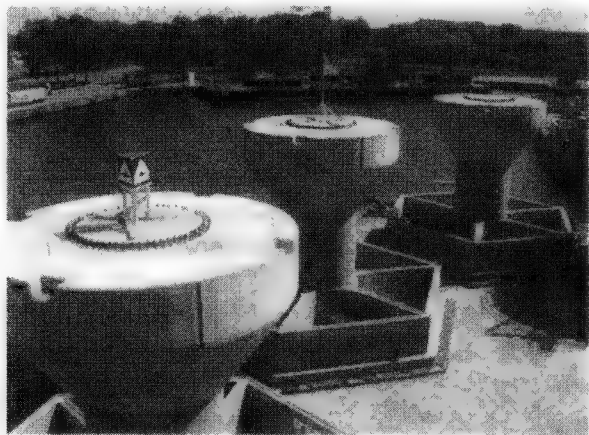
在特殊的驳船上为 Lillgrund 风电场建造的混凝土制造的重力式基础（© HOCHTIEF Construction AG, 城市工程和海事工作，汉堡，德国）
